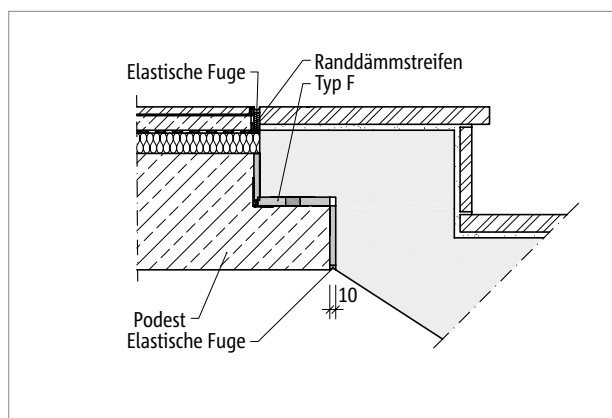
Schöck Tronsole® Typ F: Brandschutzausführung
